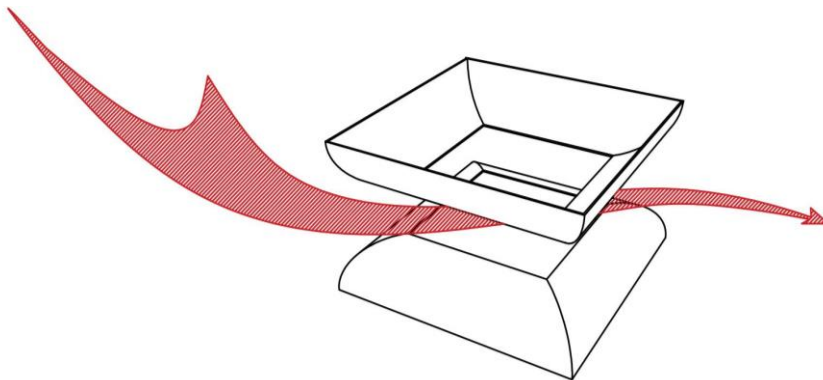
Intégration de dispositifs éoliens dans des ailes en toiture (retournement de la toiture) afin d'accélérer la veine d'air.
